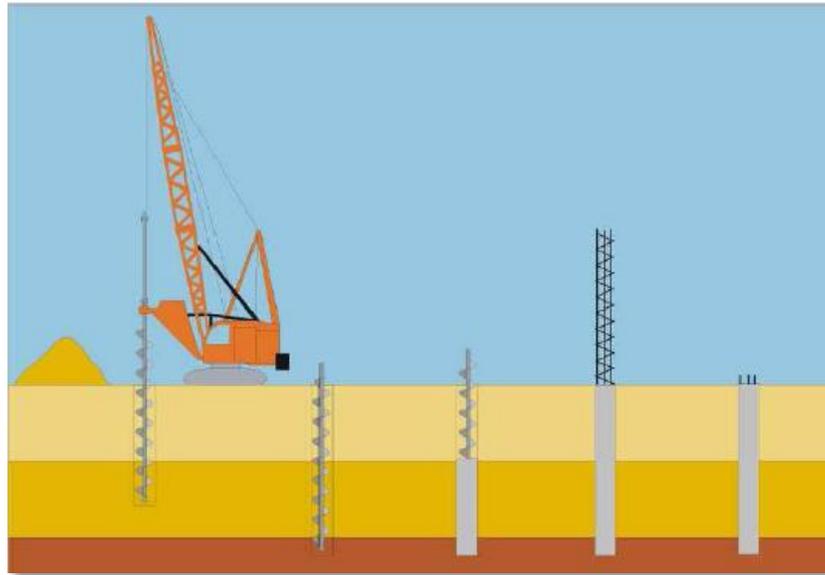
Proceso de barrena continuo, colocación de acero y vaciado de concreto
